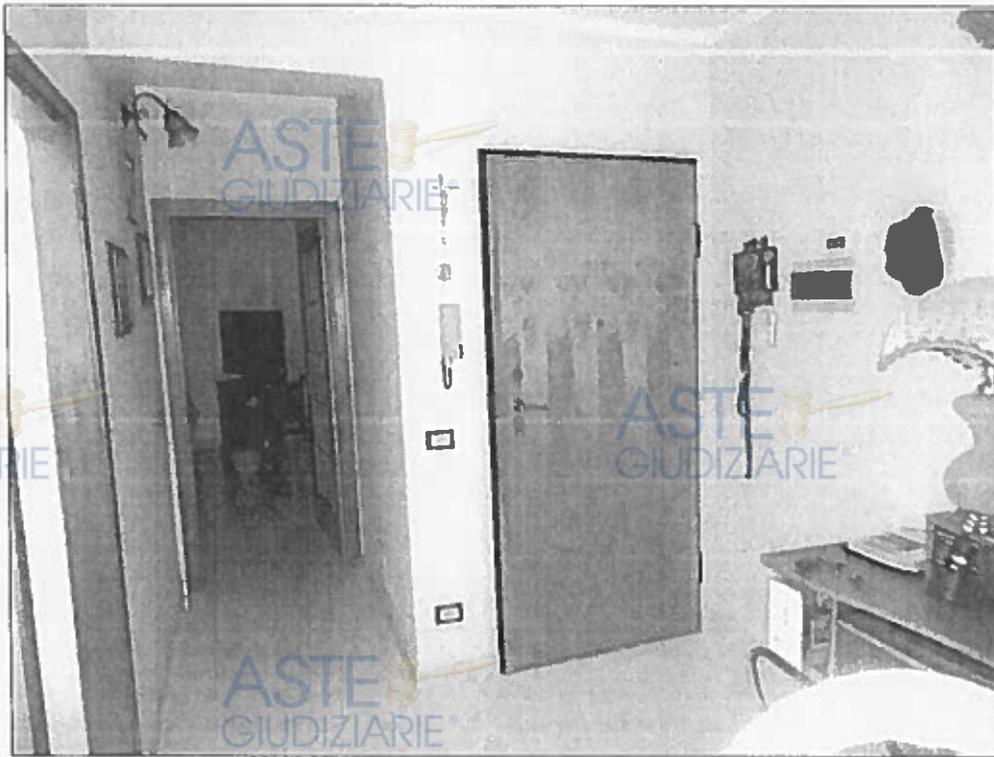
APPARTAMENTO SUB 6 - INGRESSO
